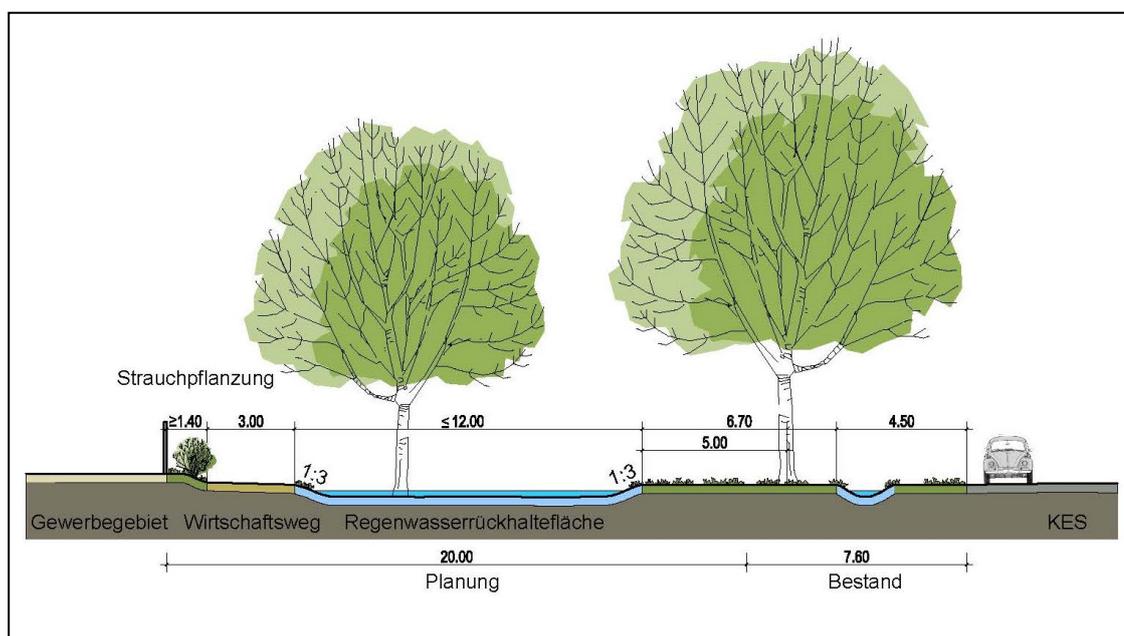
Schnitt durch die geplante Regenwasserrückhaltefläche im Bereich der vorhandenen Straßenbäume, planerzirkel 2019
